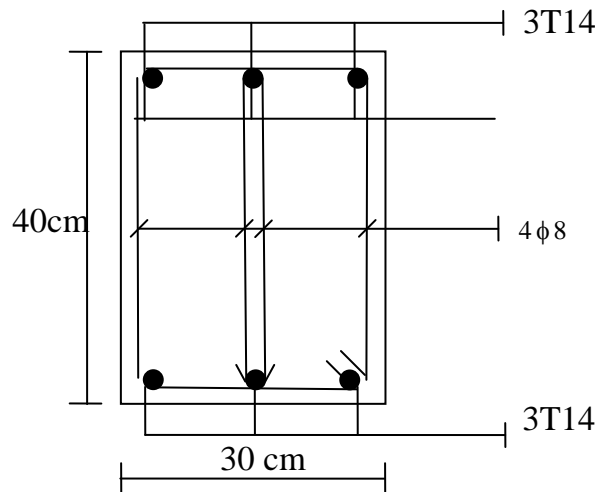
Schéma de ferrailage de la poutre principale (Travée)
